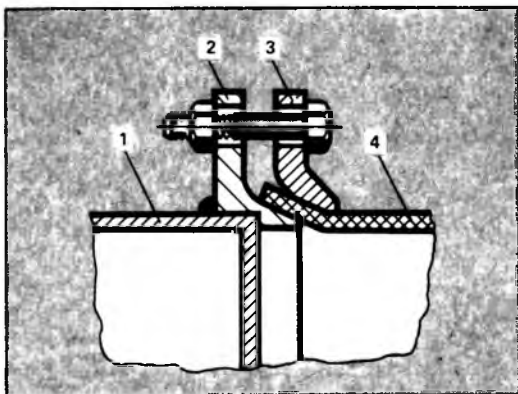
Разъемное соединение полиэтиленовой трубы со стальной: 1 — стальная труба, 2 — фланец с наружной конусной частью, 3 — фланец прижимной с внутренней конусной частью, 4 — пластмассовая труба
